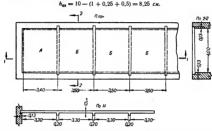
77. Схема железобетонного перекрытия с плитами, опертыми по контуру.
